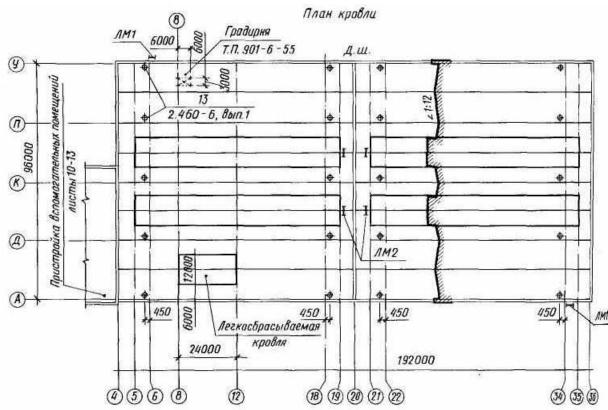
Пример выполнения плана кровли промышленного здания
